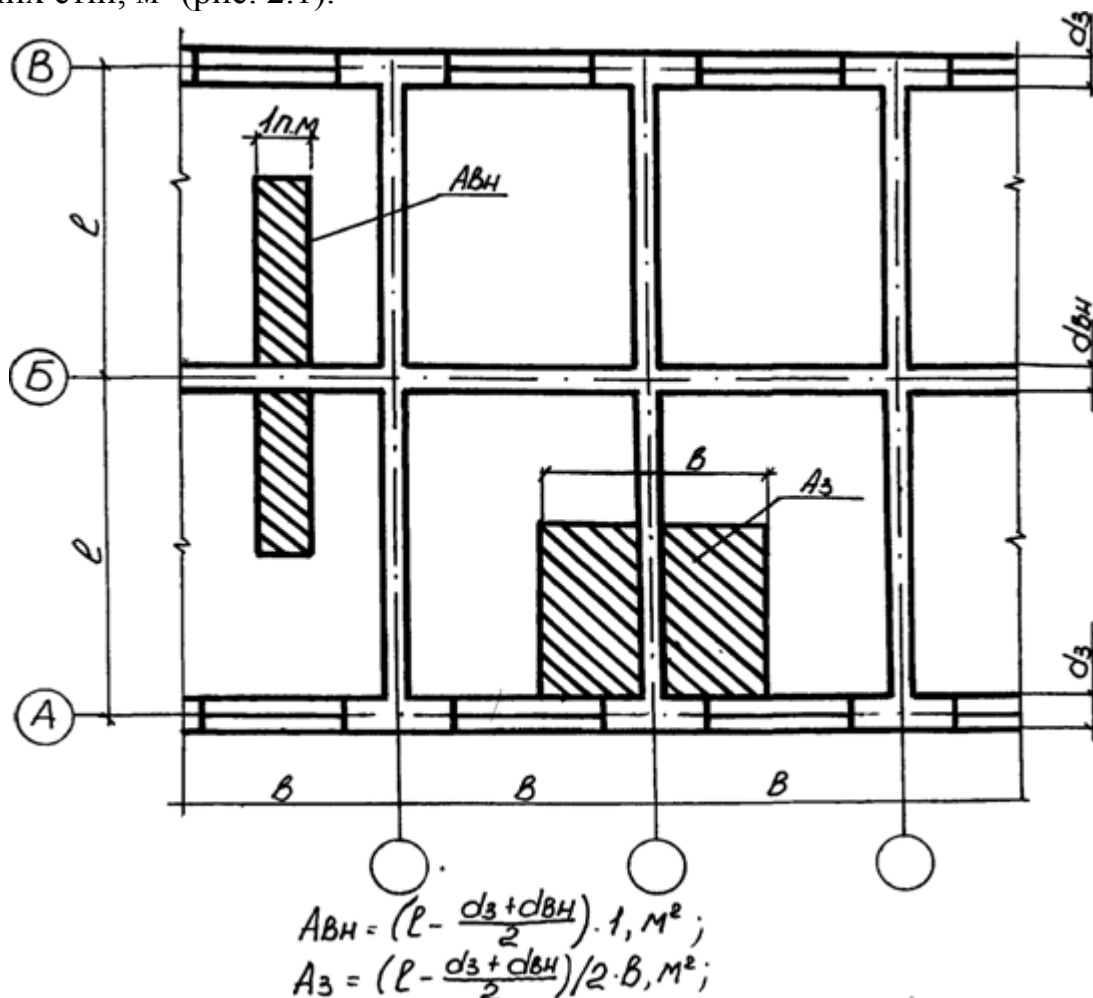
Схематичний план будівлі та вантажні площі для розрахункових фундаментів
